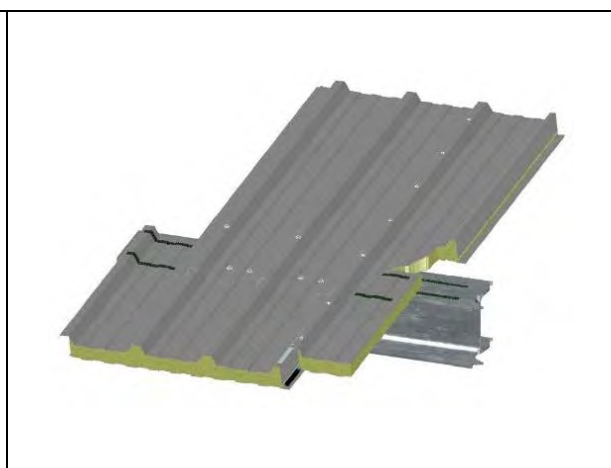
Stahl-Sandwichelement (Dach)
